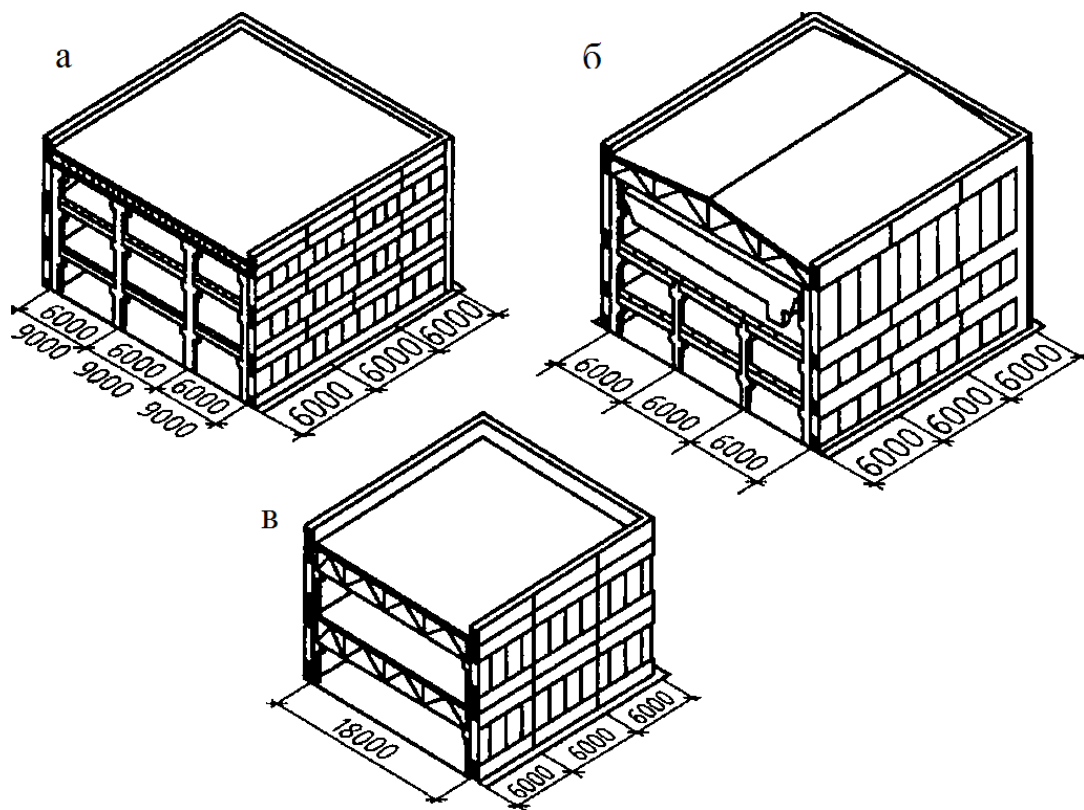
Об’ємно-планувальні рішення багатопверхових каркасних промислових будівель: а – уніфікованого типу; б – з верхнім поверхом; в – з міжфермовими поверхами
